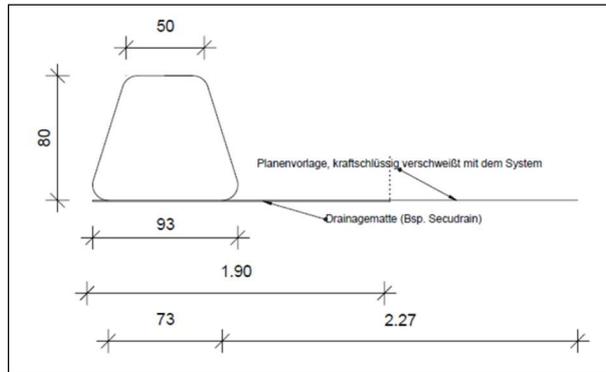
Konstruktionszeichnung mit kraftschlüssig verschweißter Planenvorlage
